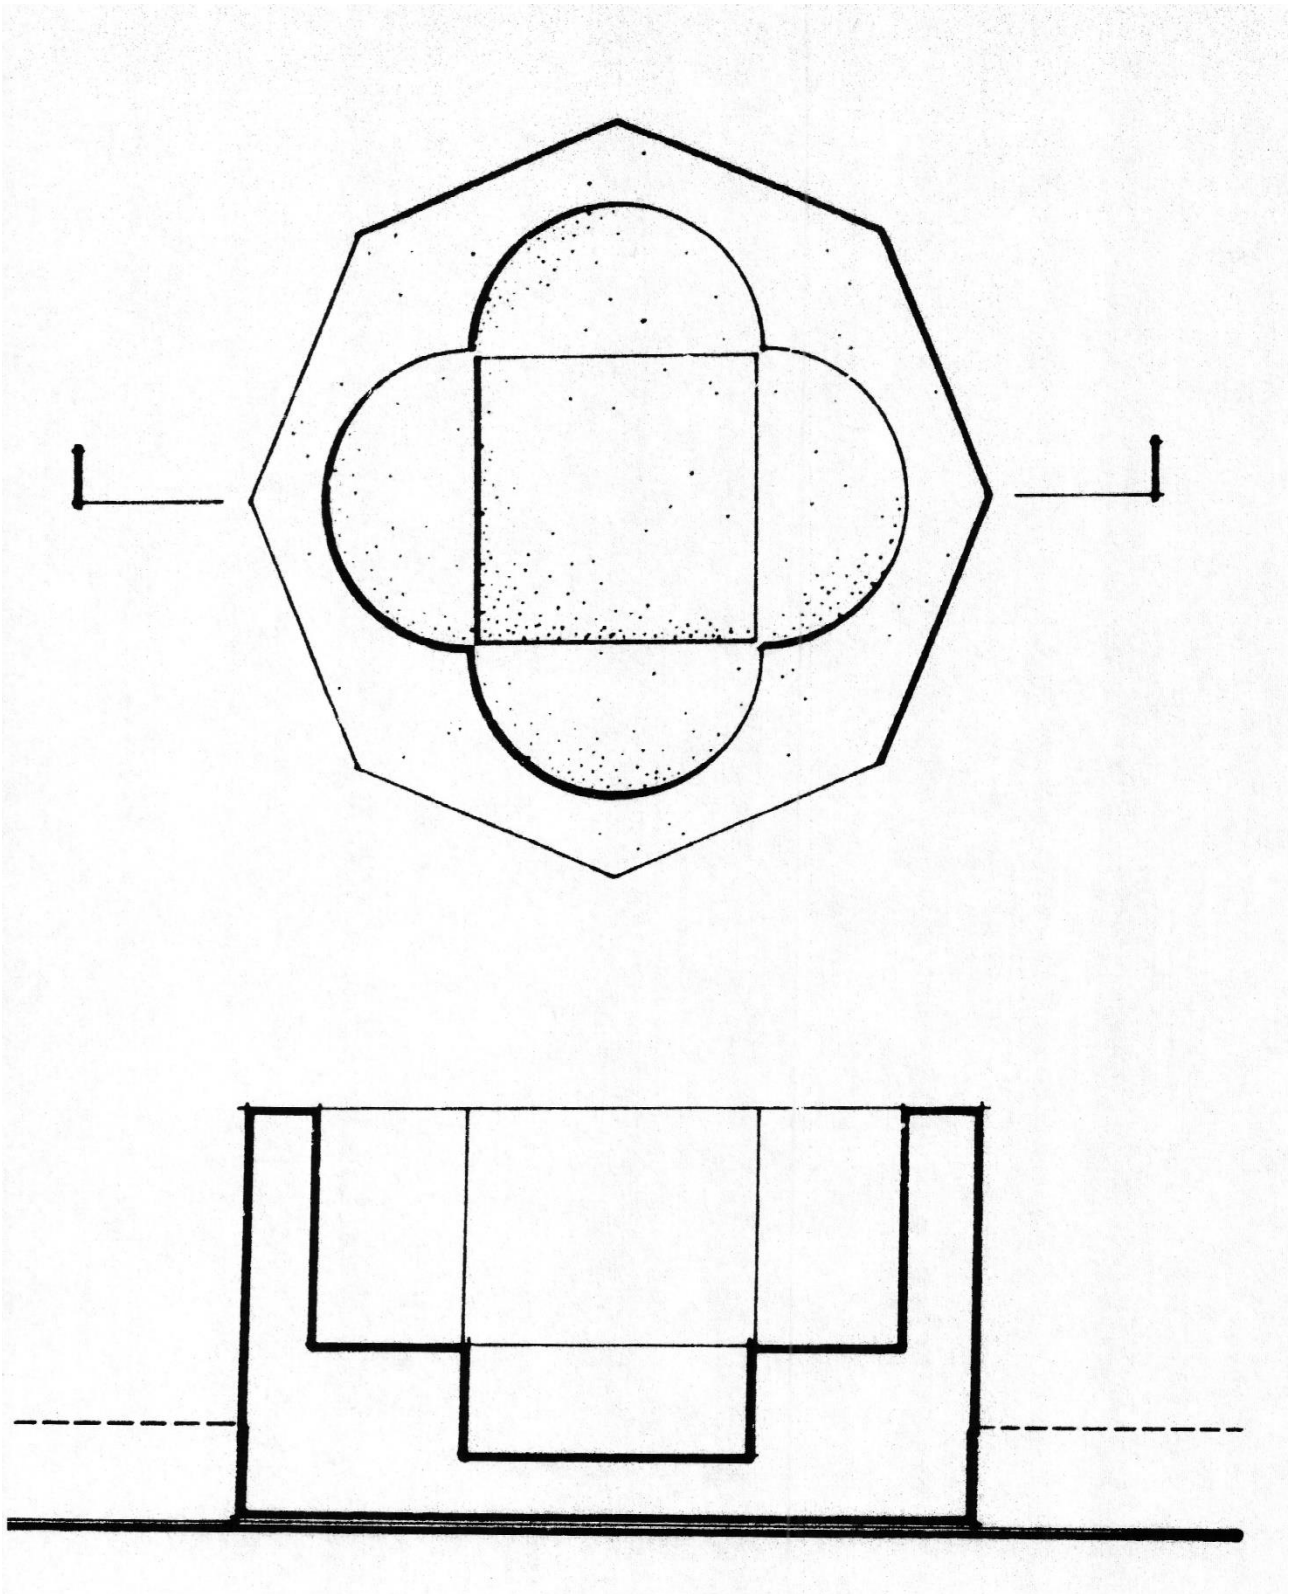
Betlemme 1. Pianta e sezione del battistero di età giustiniana
